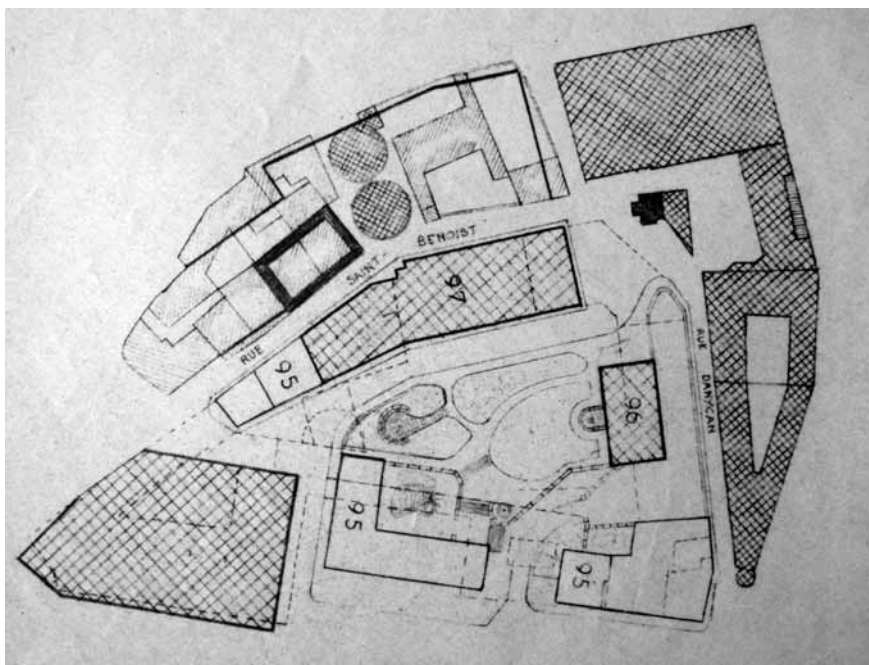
Plan du réaménagement de l'enclos des Bénédictins : reconstruction de la sous-préfecture (îlot 96) et du tribunal (îlot 97) (Arch. mun. Saint-Malo, 1 W 165, 1949-1960)
